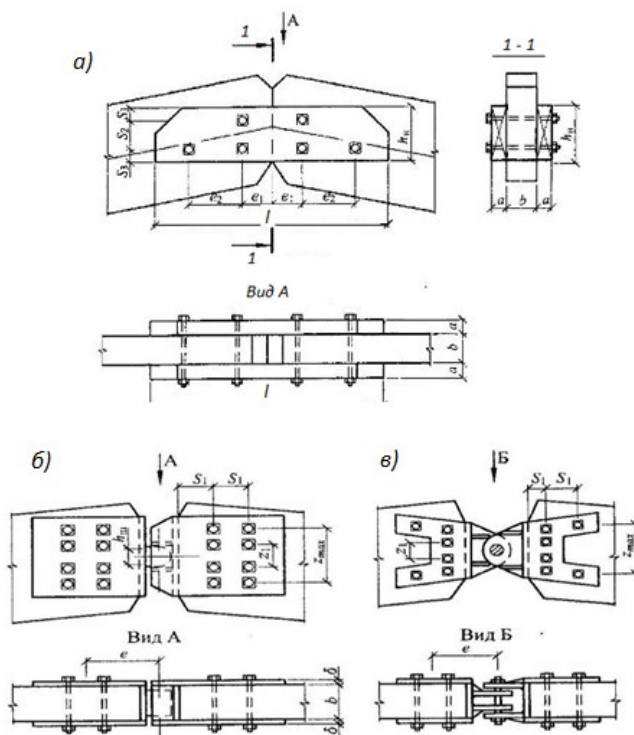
Конструктивное решение конькового узла арки лобовым упором с деревянными накладками(а) и классическими шарнирами (плиточный шарнир - (б); валиковый шарнир - (в))
